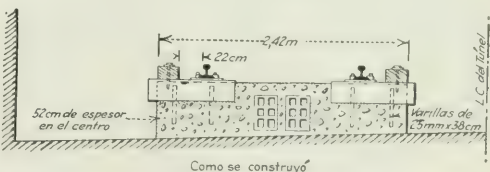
VÍA RÍGIDA DE HORMIGÓN PARA TÚNELES
